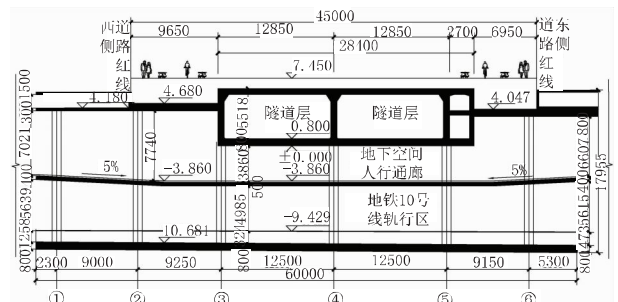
下穿式隧道与地下空间共构断面图(单位:mm)
